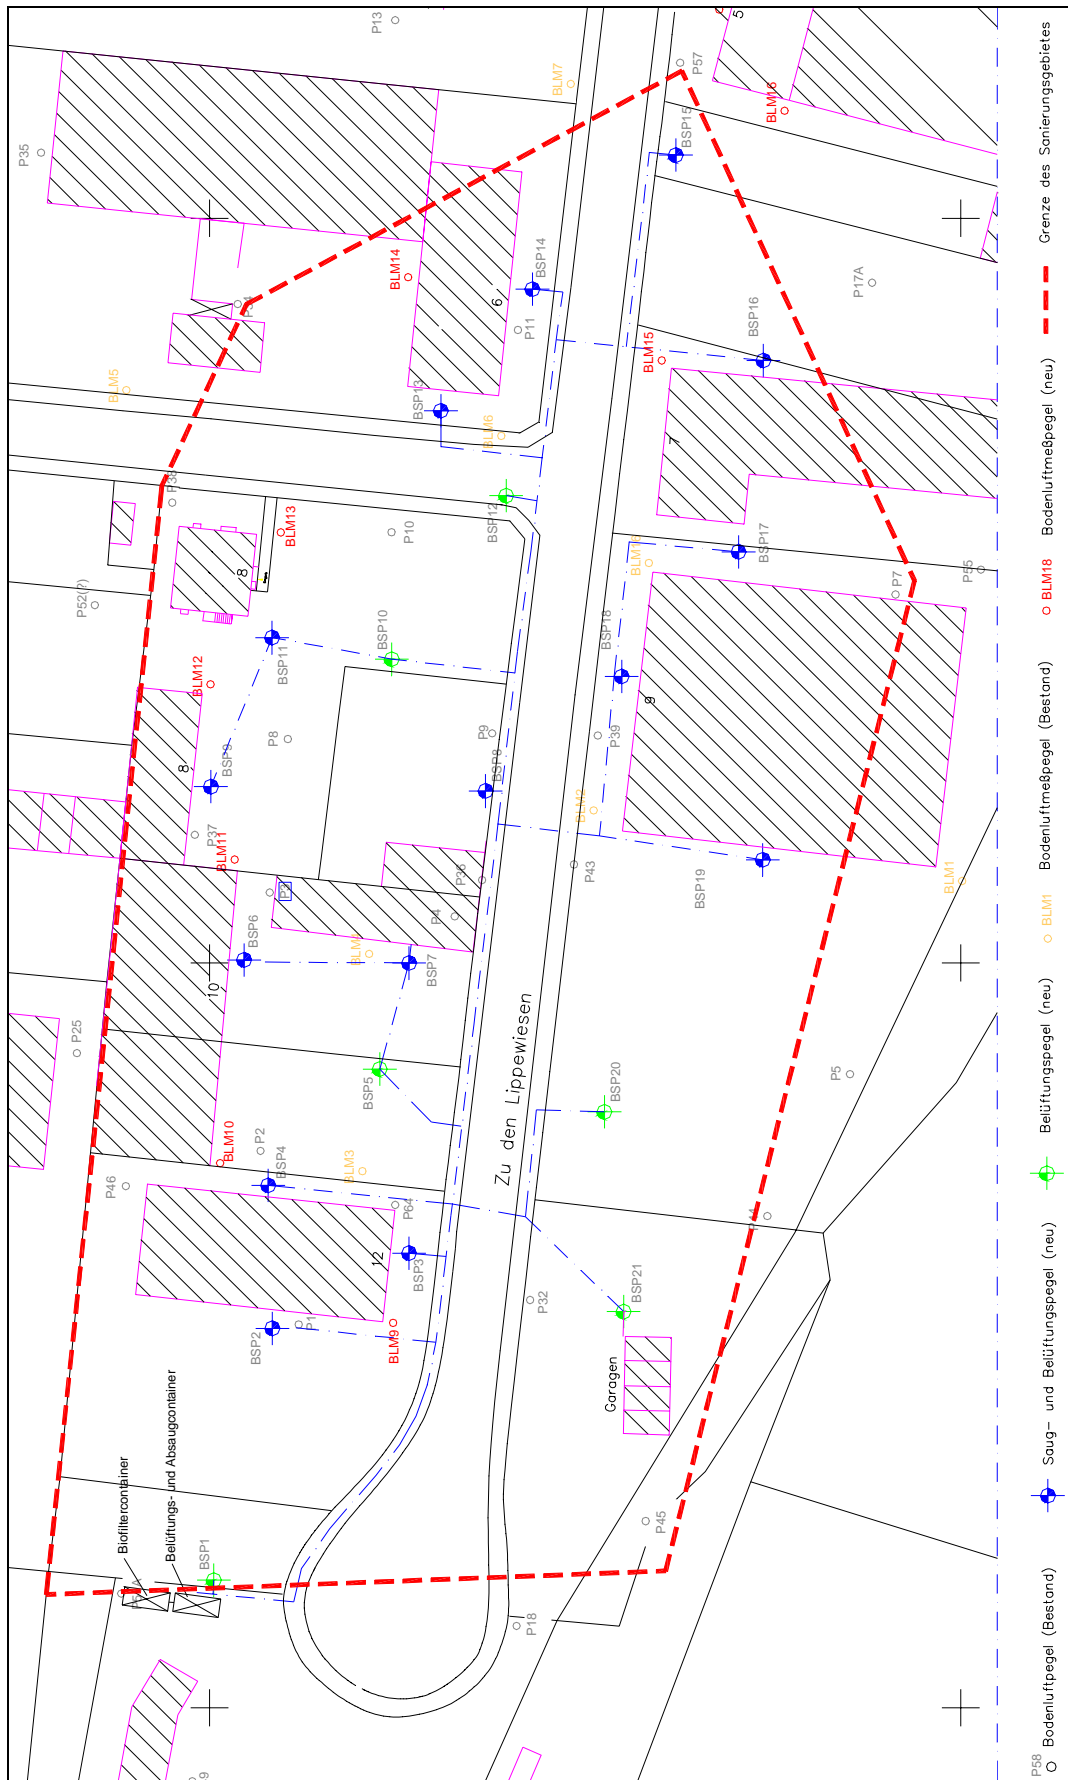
Lageplan des Sanierungsbereiches der Altablagerung Lorenkamp mit Einrichtungen zur In situ-Be- und Entlüftung
